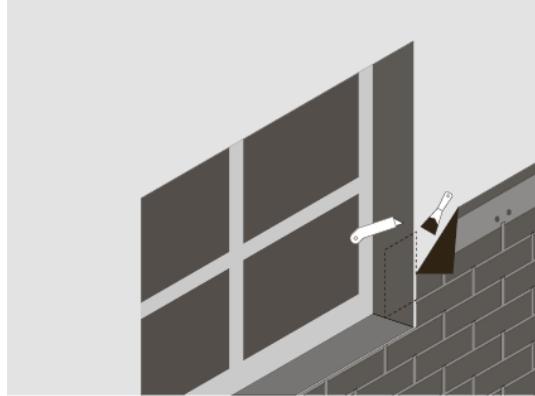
Монтаж фасадной плитки вокруг оконных проемов
